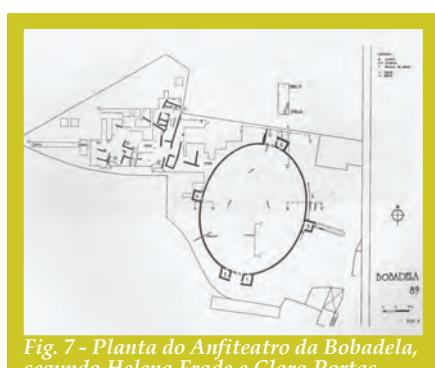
Planta do Anfiteatro da Bobadela, segundo Helena Frade e Clara Portas
